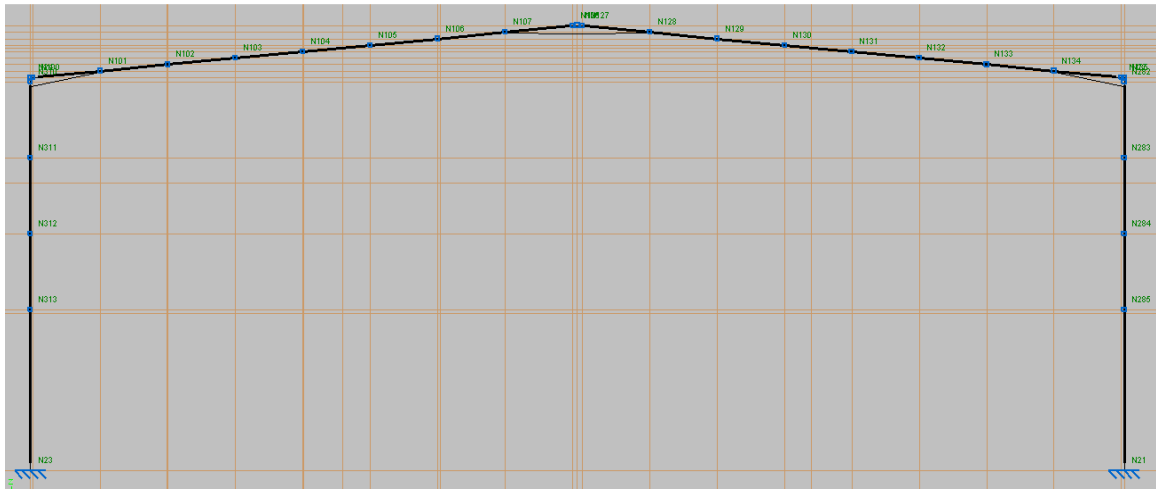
Pórtico de cálculo en vista frontal.
